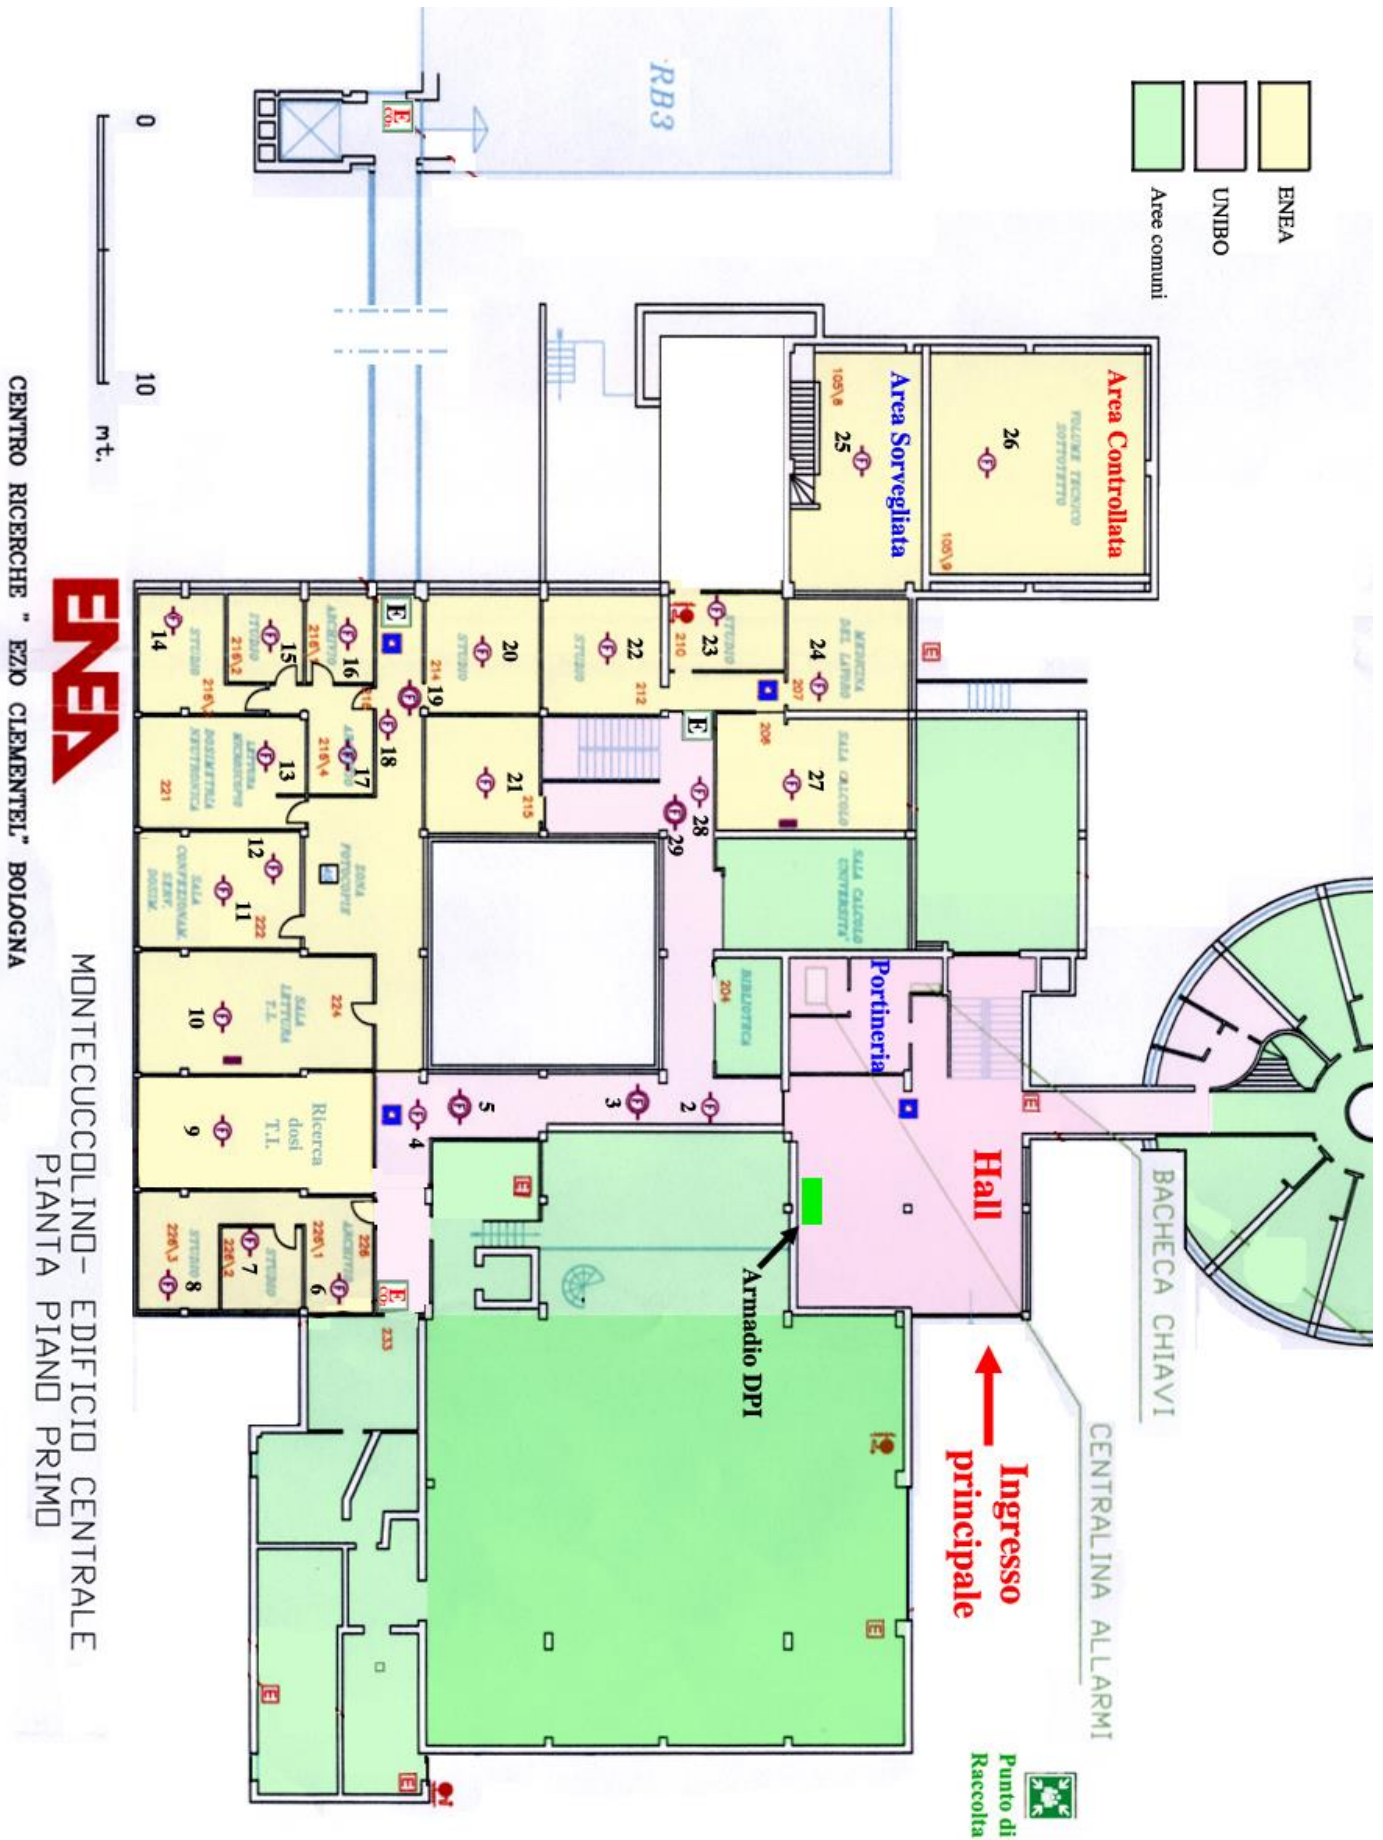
Laboratori di Montecuccolino – Pianta piano primo
